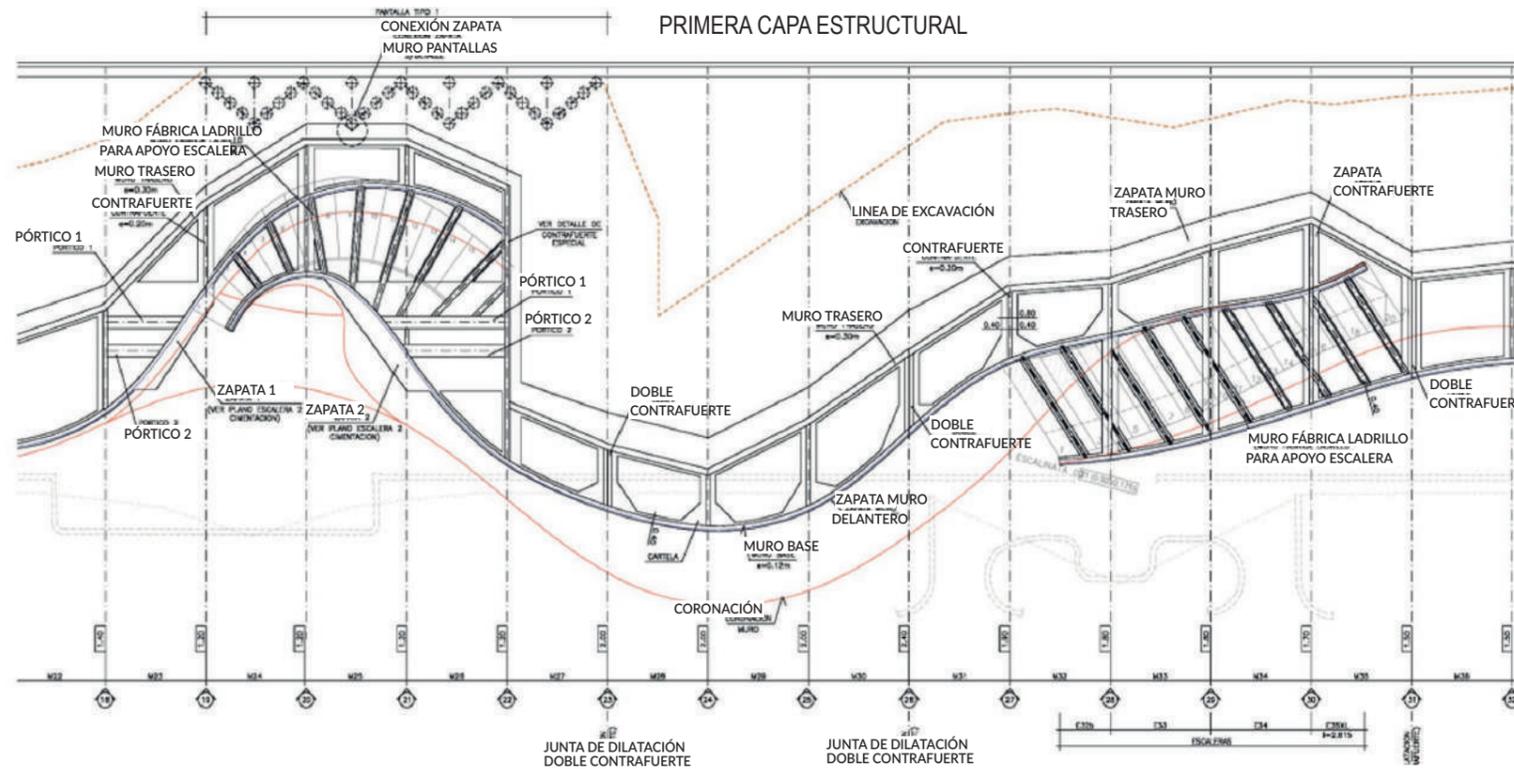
Planta estructural del paseo marítimo Benidorm. Fuente: Arquitectura Viva, 2020.
